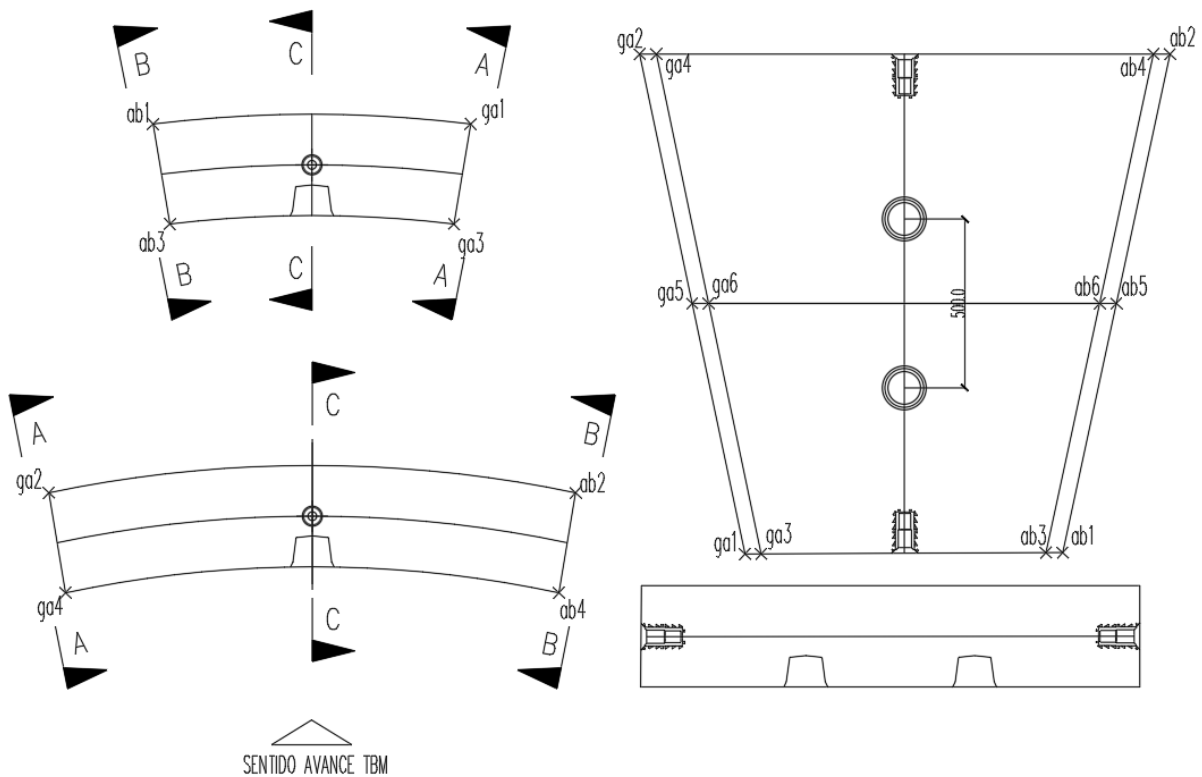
Plano esquemático de elementos en juntas en llaves (conectores / barra de guiado).
